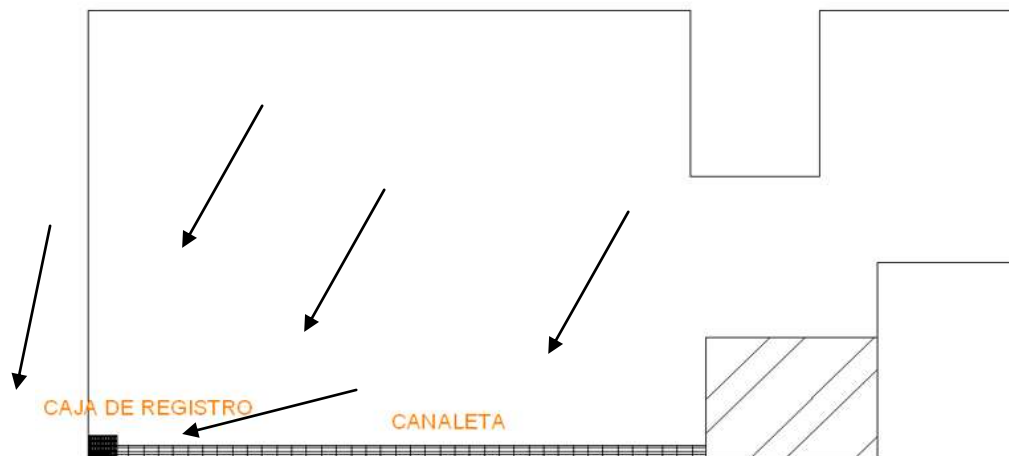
Conducción de agua pluvial y de riego hacia bajante.
